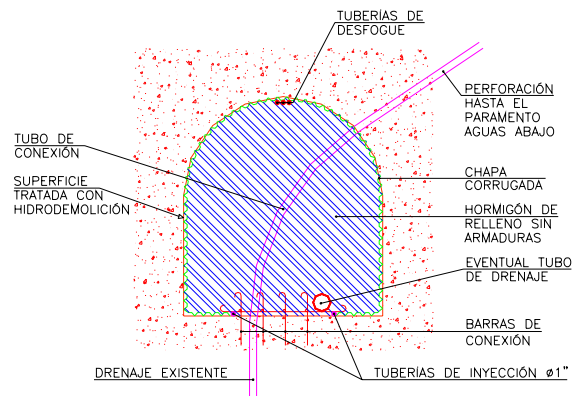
Sección esquemática de la galería, el macizado de hormigón, la chapa y el desvío de drenes
